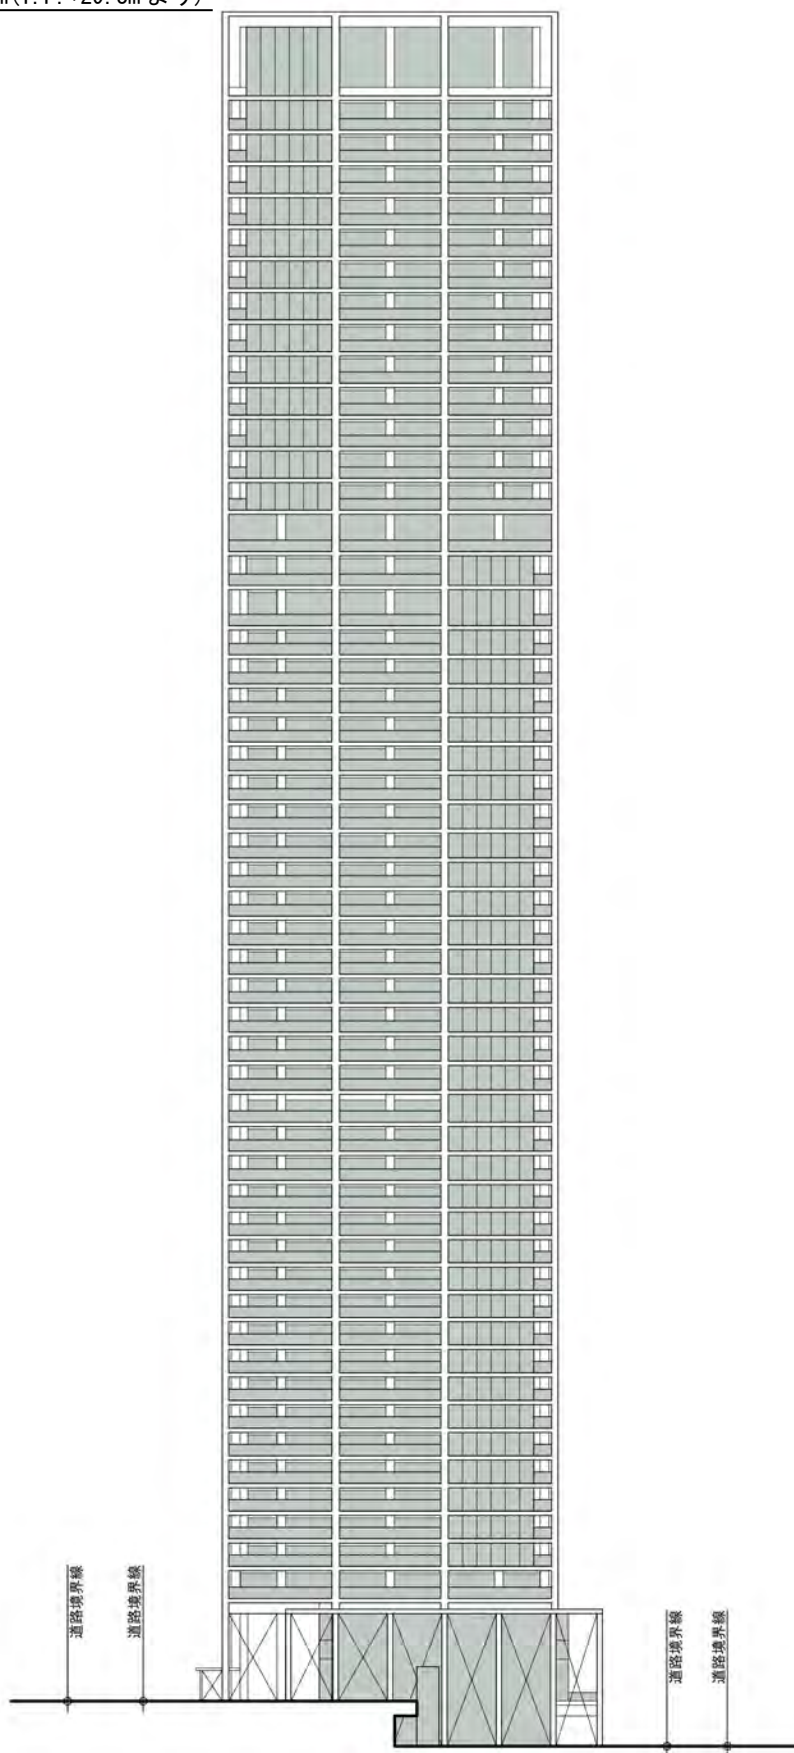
(5) 立面図（南立面図 S=1:1,000）【変更前】
